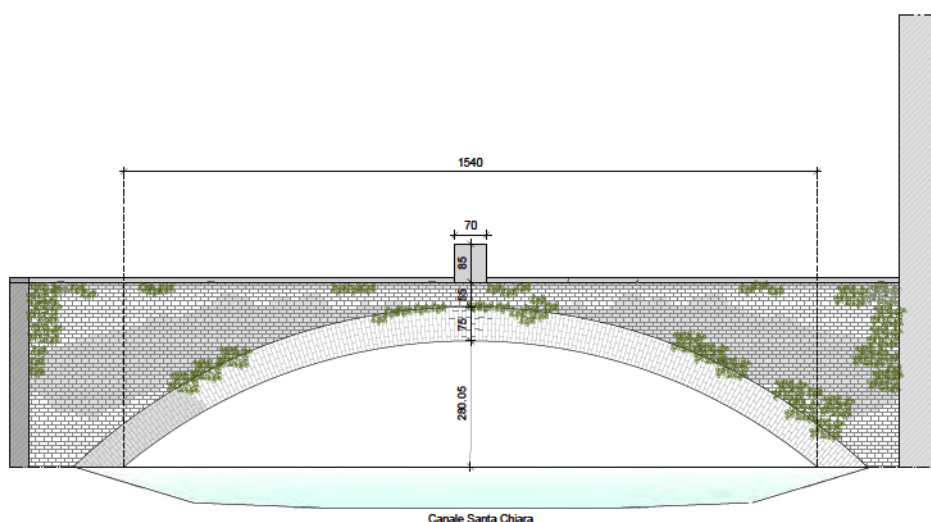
Prospetto di monte del Ponte del Maglio
